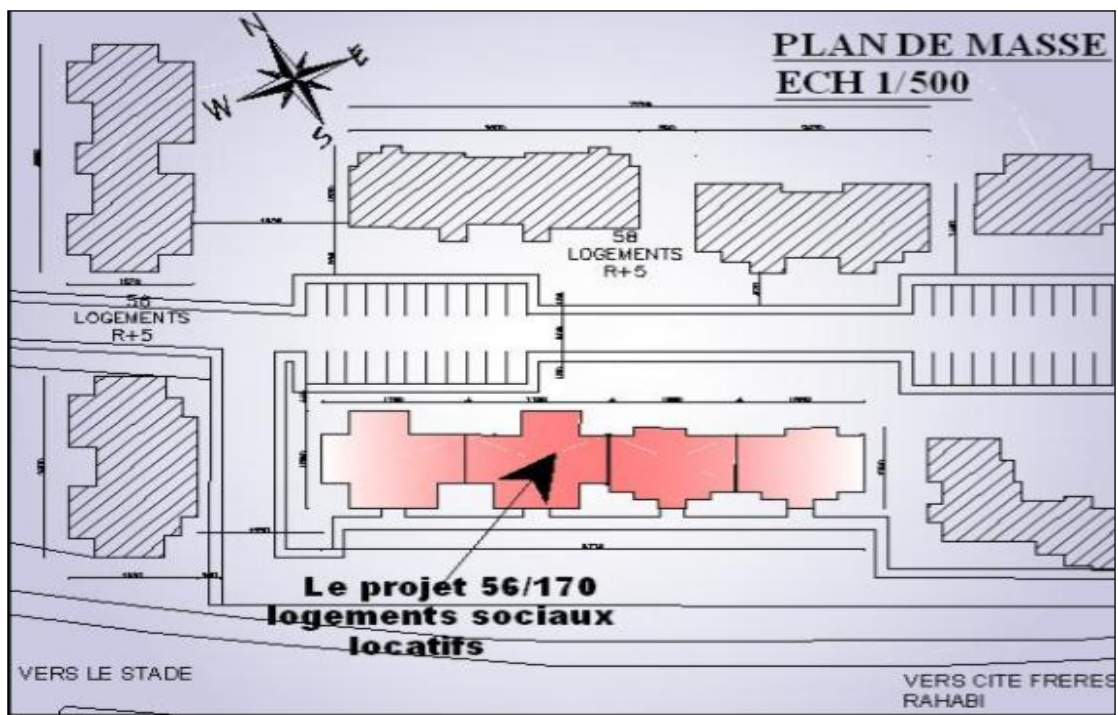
Plan de masse (284 logement) , source BET Hallaci
